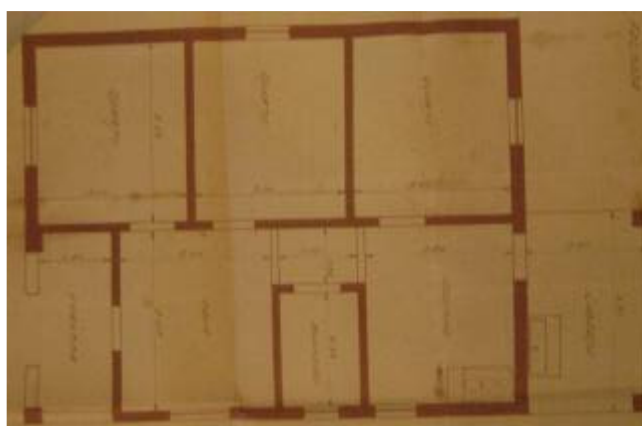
Planta Baixa proposta pelo construtor da casa Alfredo Munch.
